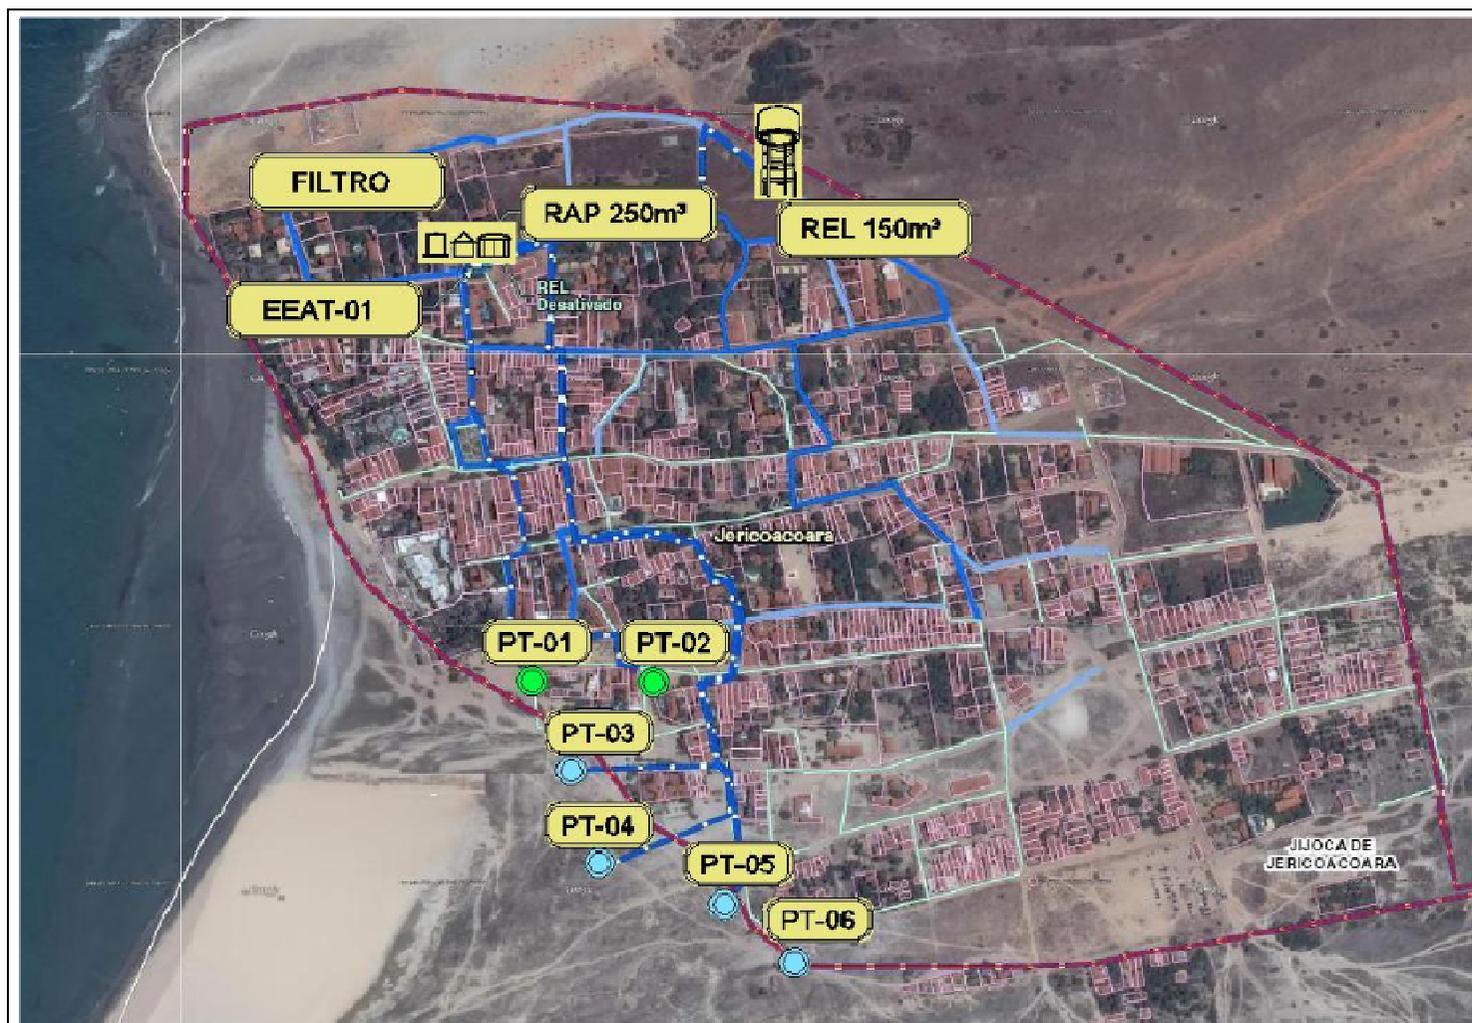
Layout Geral do Sistema de Abastecimento de Água Existente
